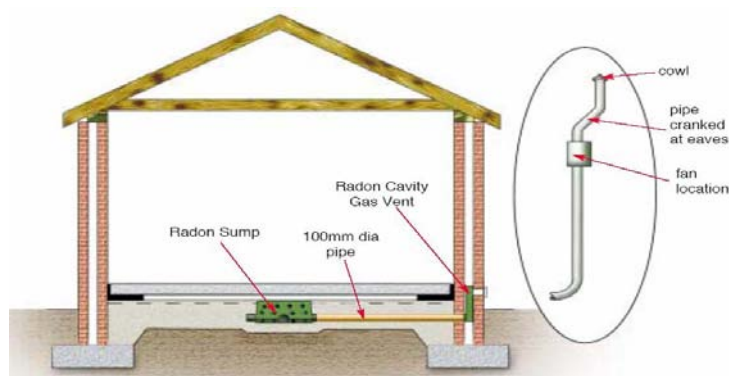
Sistema prefabricado de captación con conexión a extractor por el exterior
